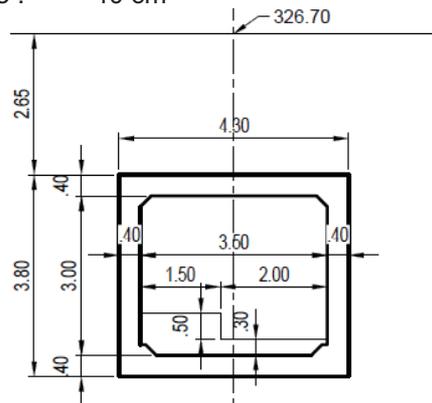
Coupe transversale de l'ouvrage projeté variante 1
